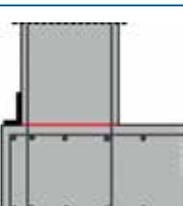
Wasserundurchlässiges Bauwerk aus Beton
